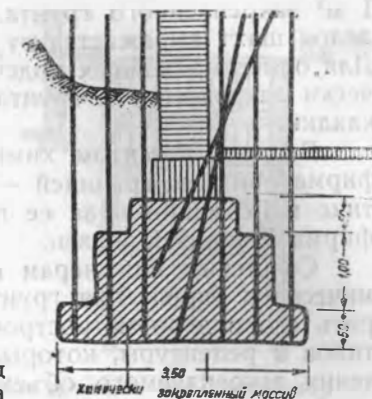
Химическое закрепление основания под фундамент из свай, заложенных в подвале дома и параллельно стене.
